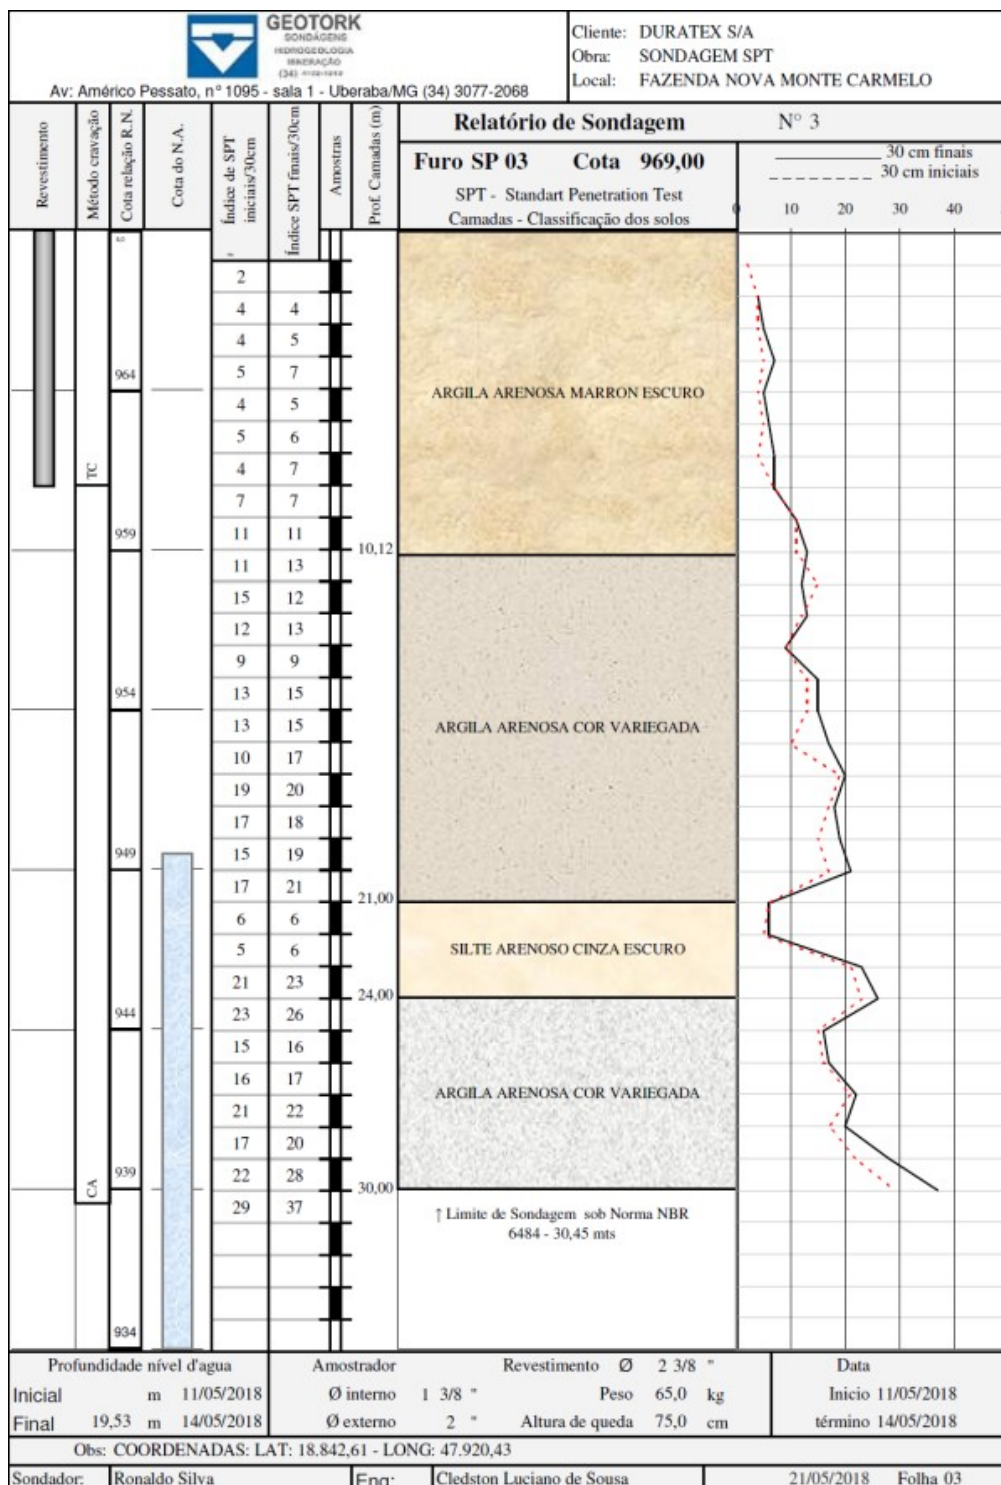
Perfil do furo de sondagem SP03. Fonte: GEOTORK, 2018.
